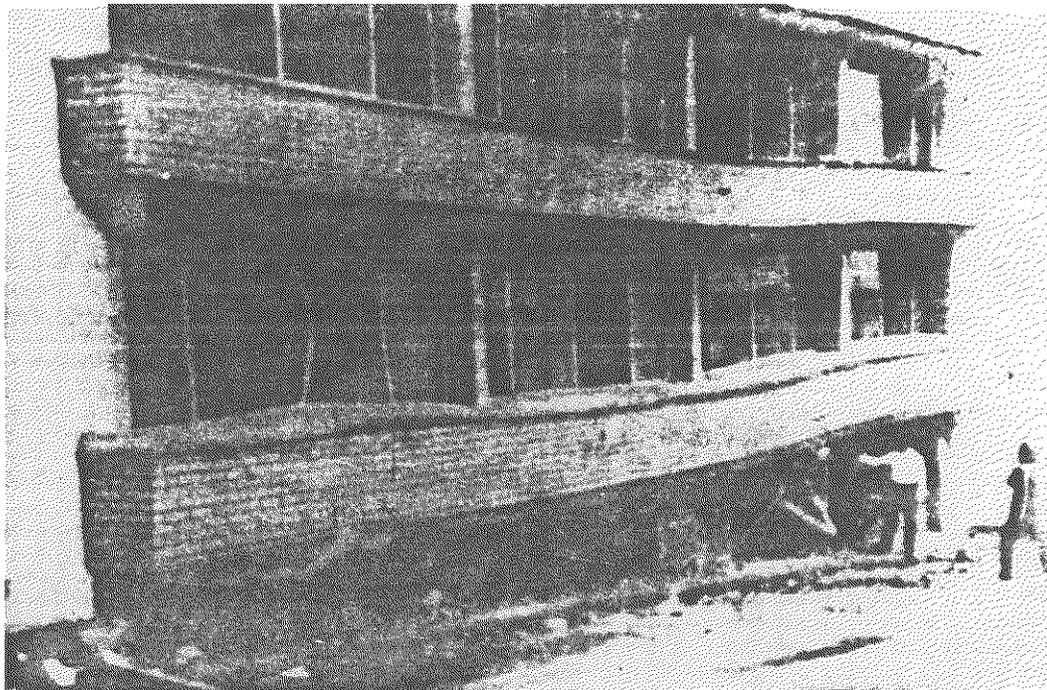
Colapso en planta baja de una edificación residencial de 4 pisos ocurrida durante el terremoto de Popayán en 1983, debido al efecto de columna corta en planta baja que produjo un hundimiento lateral de la edificación. (foto Salvatierra)
